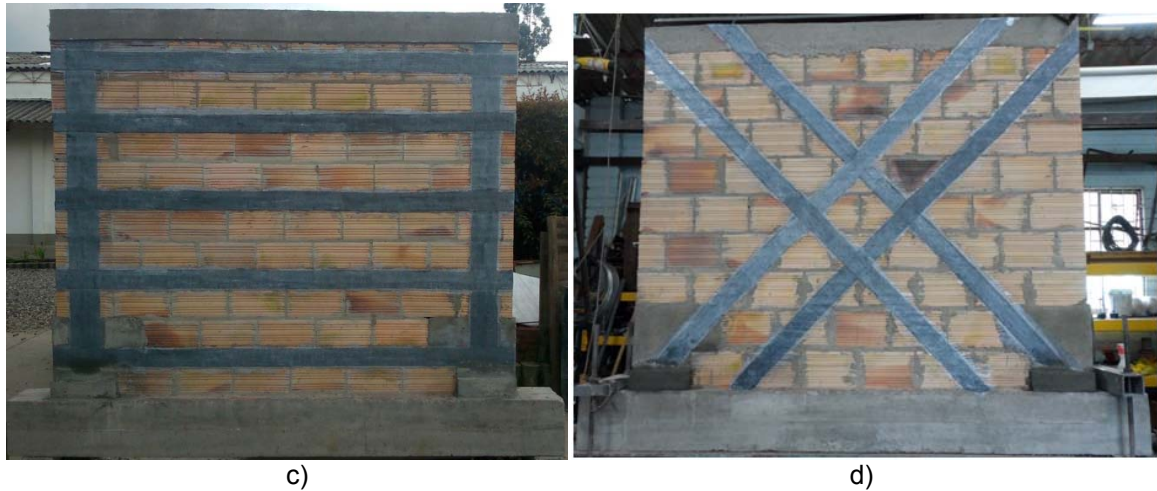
Muros reforzados con sistema de anclaje No 4.
